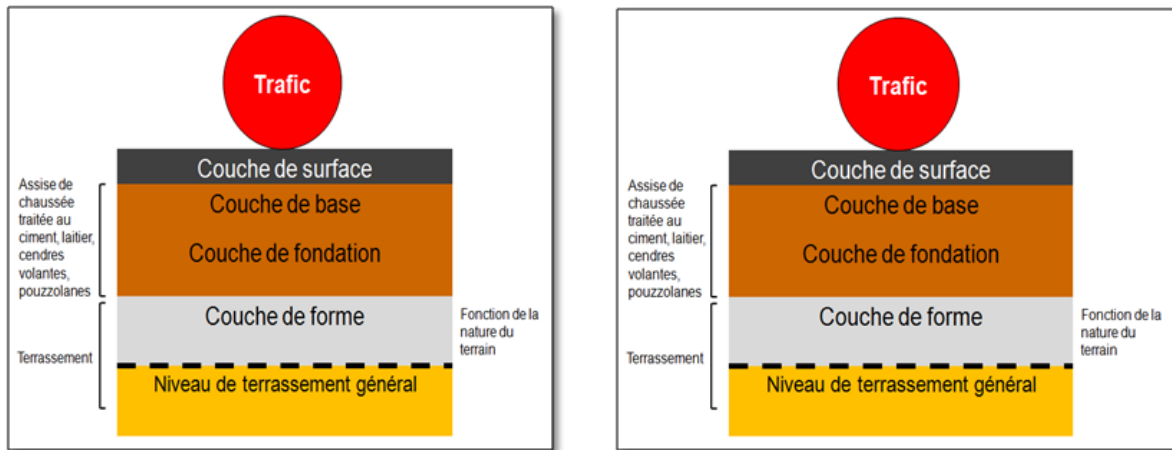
Structure type d'une chaussée semi-rigide.
